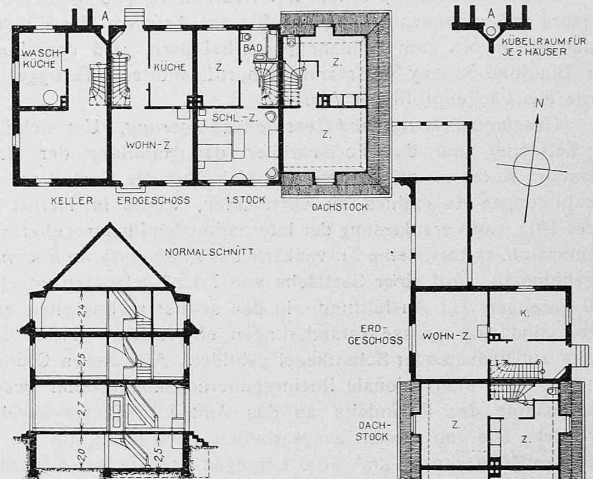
Grundrisse und Schnitt. — Masstab 1:400.
